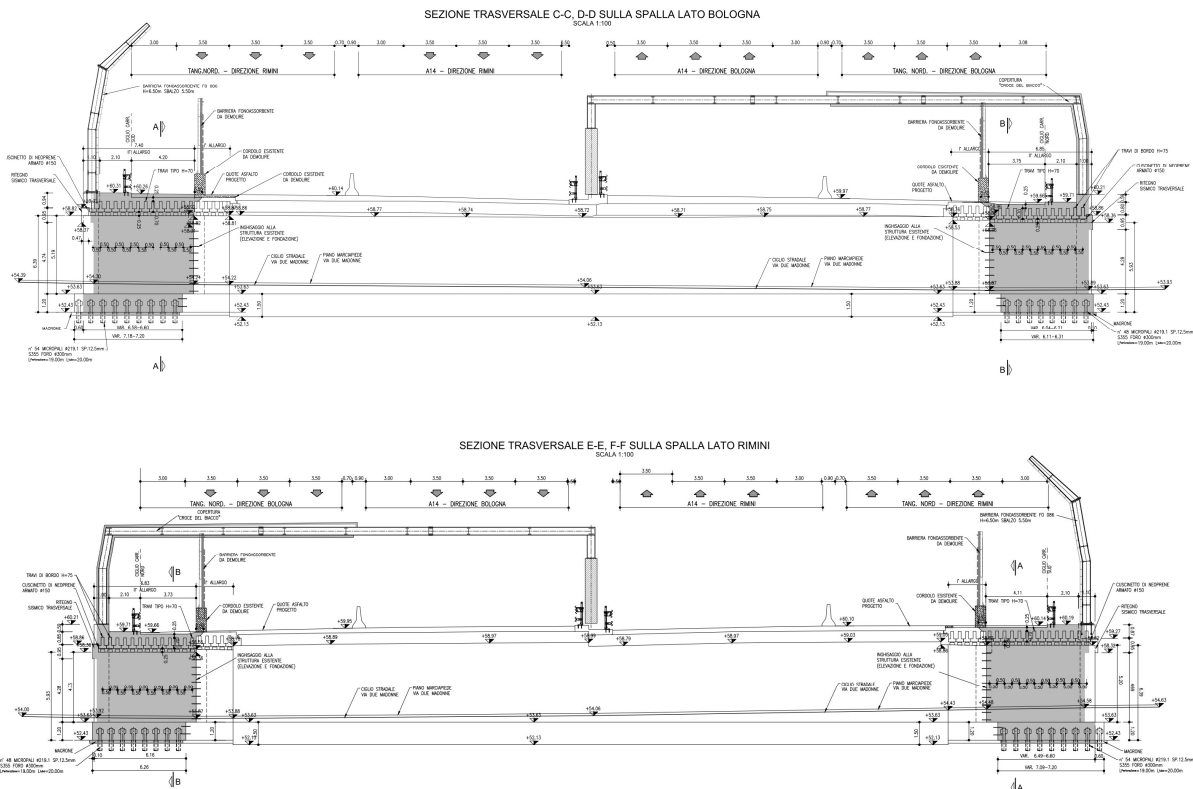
Sezioni trasversali sulle spalle
